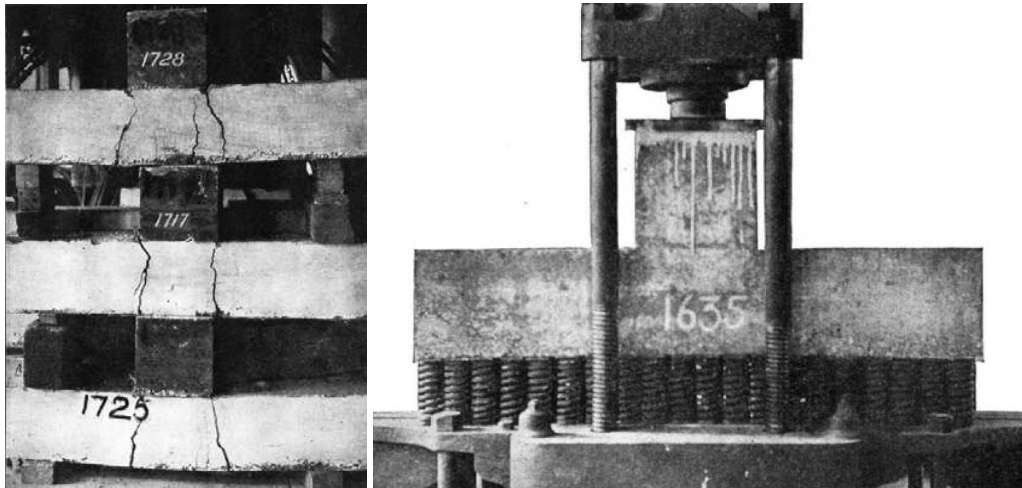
Ensaio em sapatas de concreto armado (TALBOT, 1913 apud FERREIRA, 2010)
